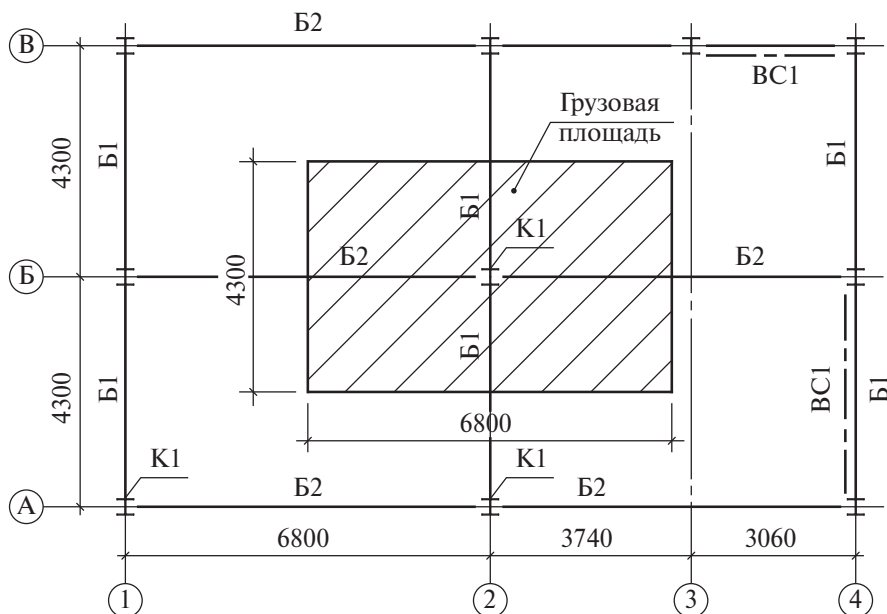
Фрагмент схемы расположения колонн и балок типового этажа для предварительного подбора сечений колонны и балки.
